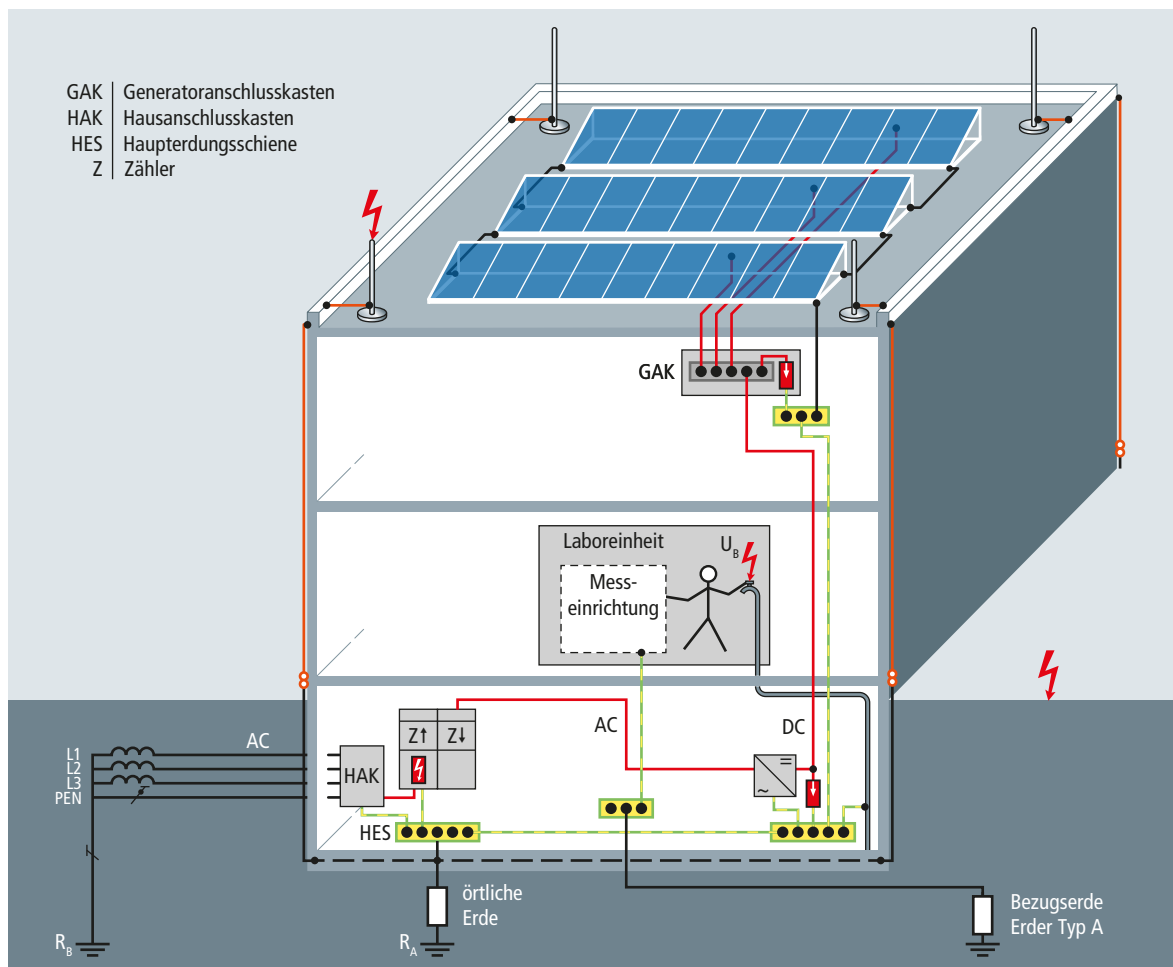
Möglicher Fehlerfall im TN-System (Beispiel: Labor): Körperschluss an Wasserleitung
